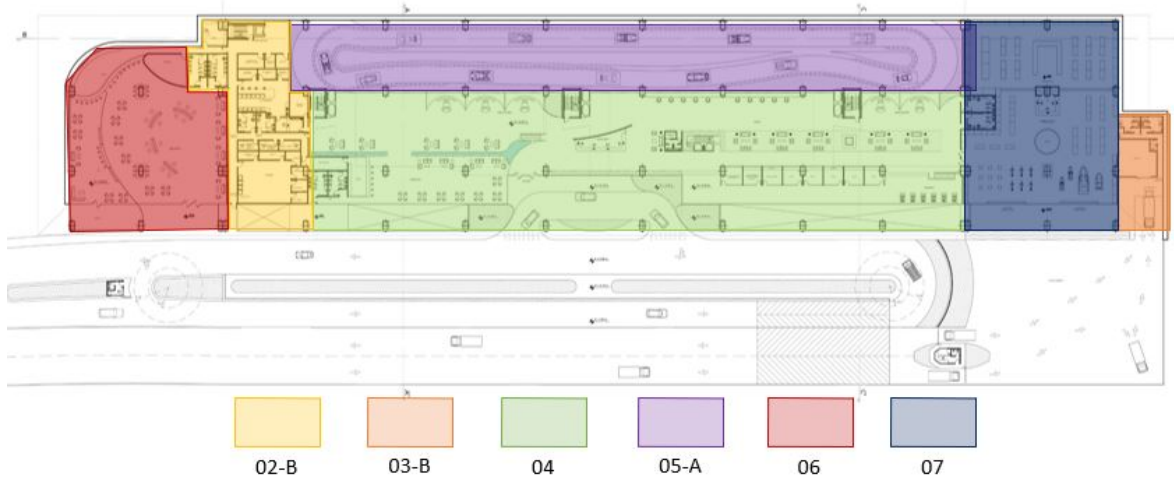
Planta Baja +0.15. Fuente: *Fase de diseño de propuesta arquitectónica – Diseño X.* (2018)
